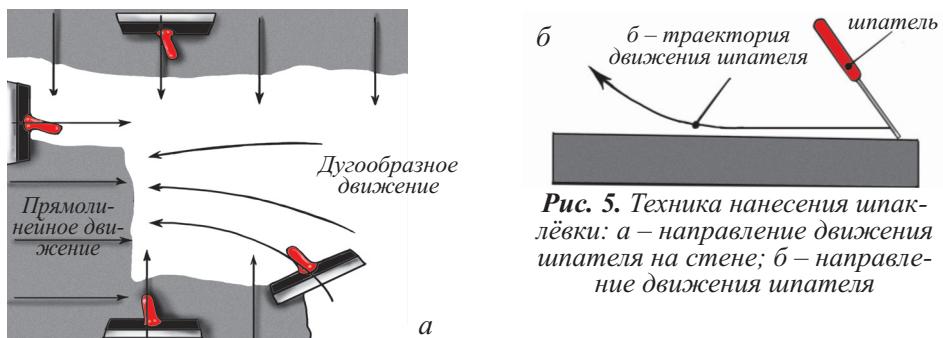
Техника нанесения шпаклёвки: а – направление движения шпателя на стене; б – направление движения шпателя
